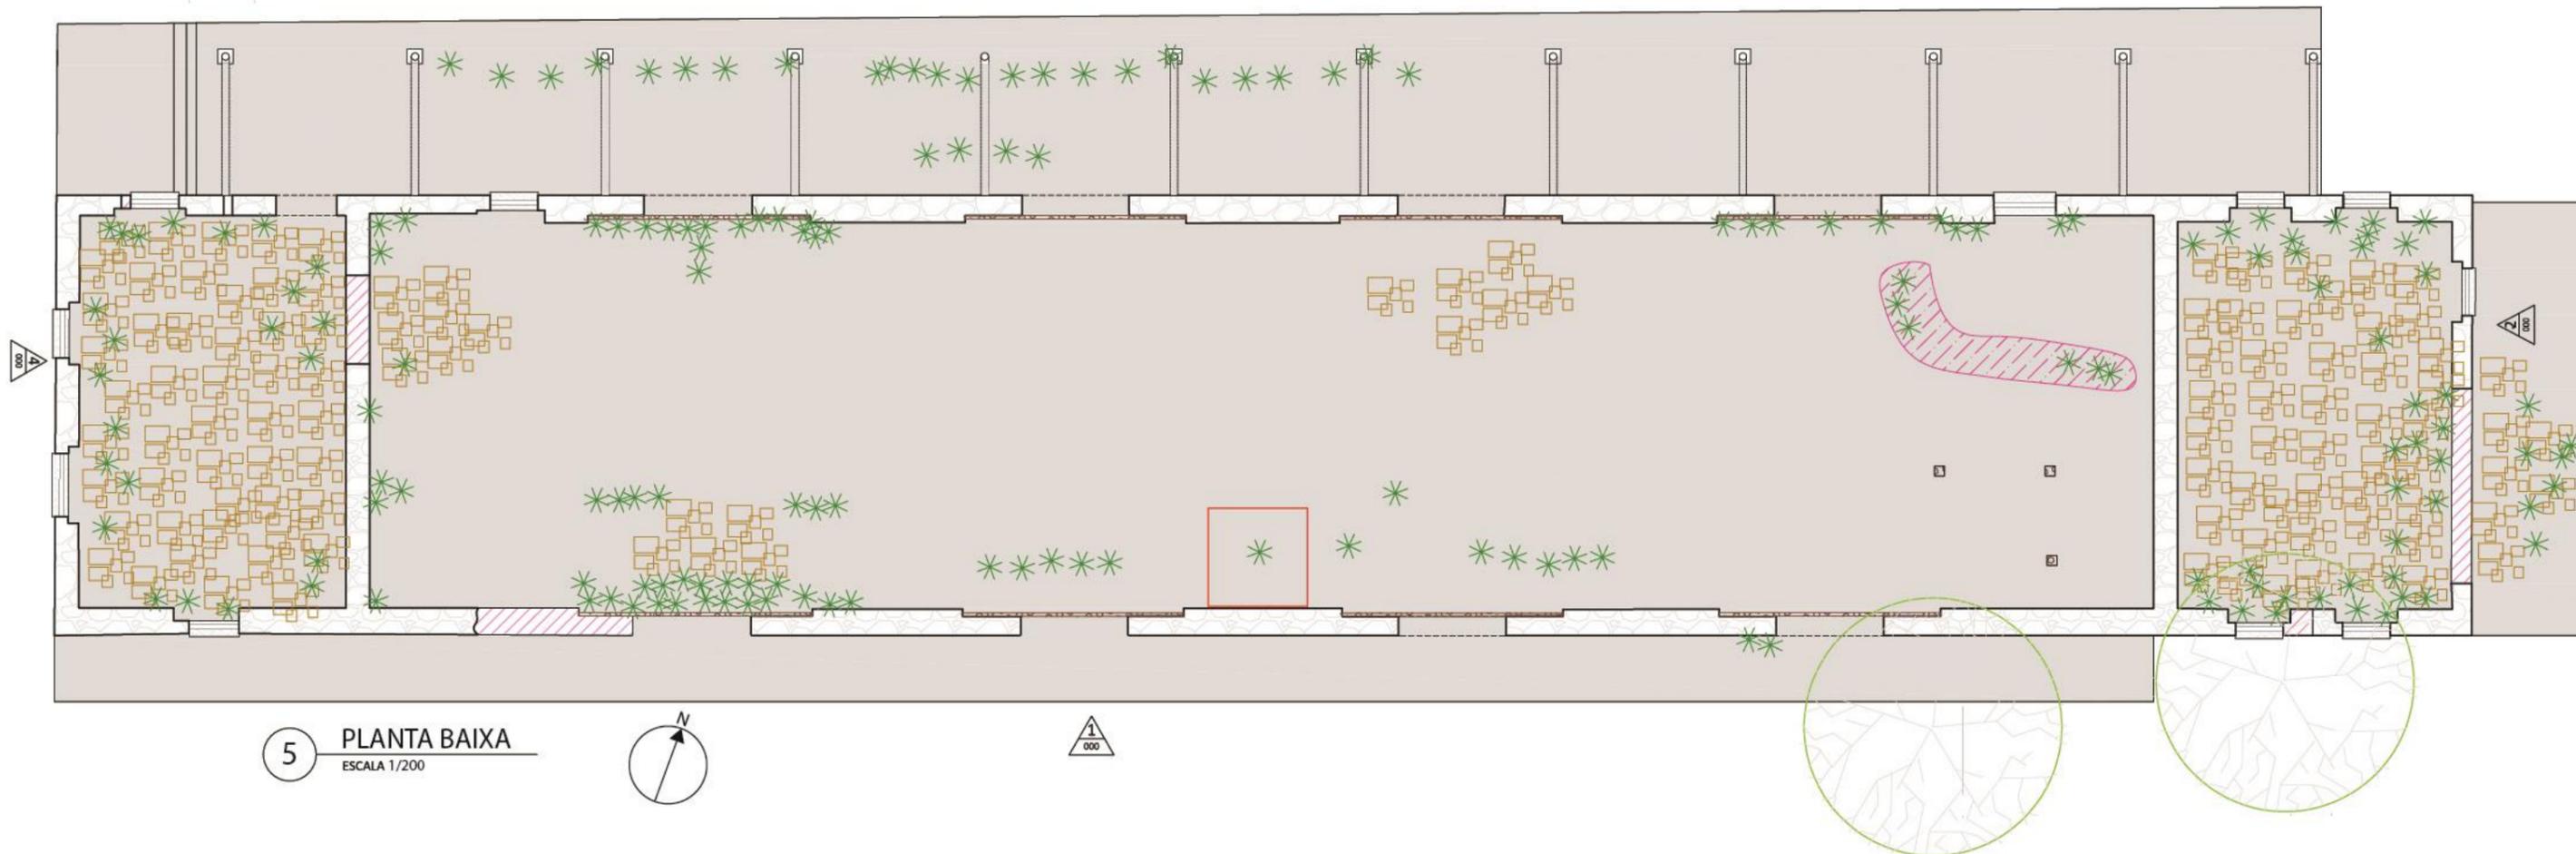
Mapeamento de danos em planta baixa. Levantamento realizado pela autora. Março 2018
